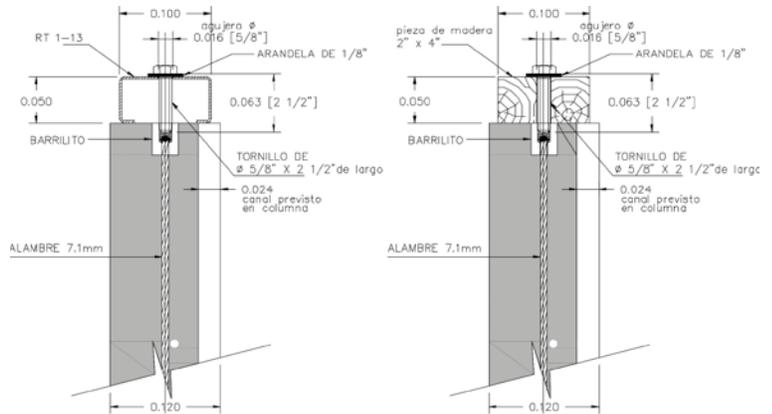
Detalle típico de colocación de solera metálica o de madera
